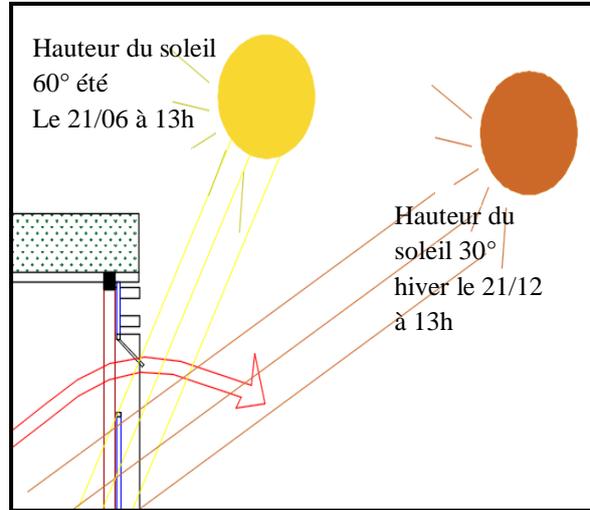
coupe montrant la ventilation naturelle et la protection solaire en été.
